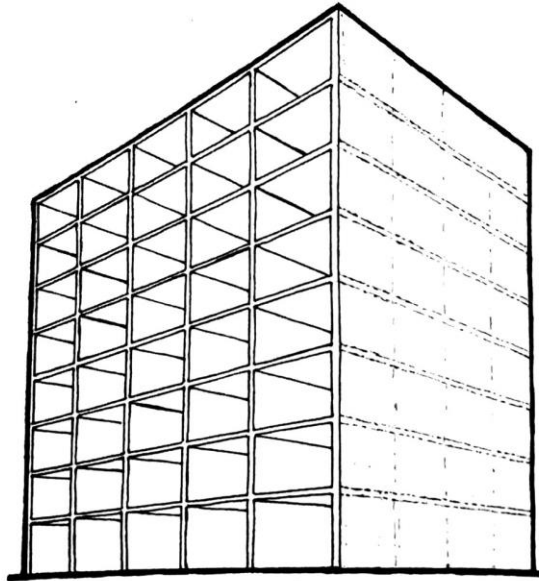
Esquema estructural de muros en concreto. Adaptado de Maldonado Rondón y Chío Cho (2007). Visión estructural de las edificaciones de la ciudad de Bucaramanga.
